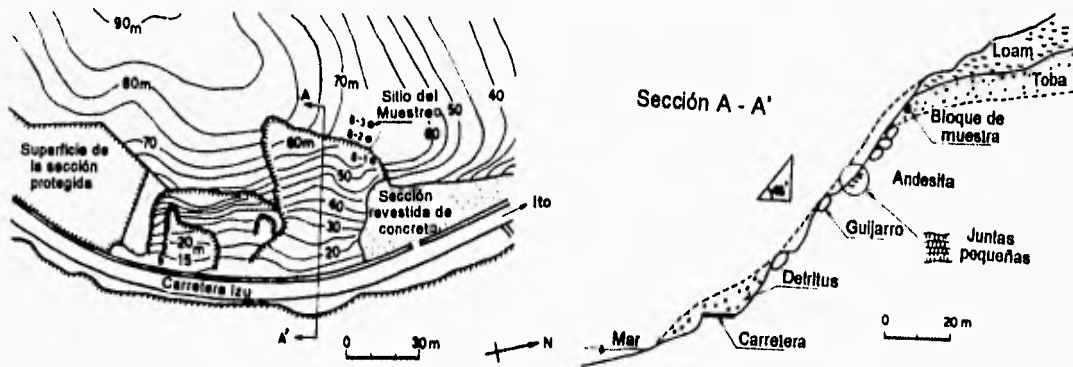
Deslizamientos de Hokkawa, Izu (planta y corte).
